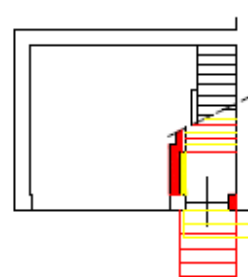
a Comparazione stato attuale – stato rilevato abitazione sub. 2
